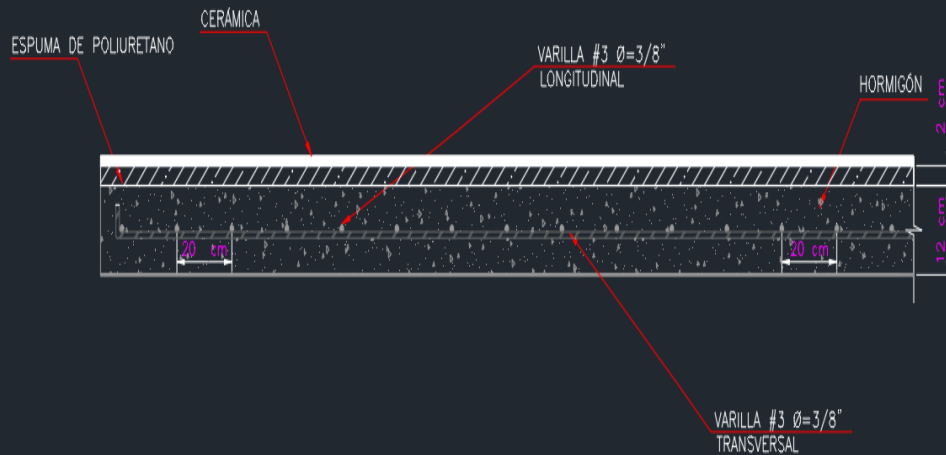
Detalle de cómo va colocada la espuma de poliuretano en la losa de hormigón armada in SITU
